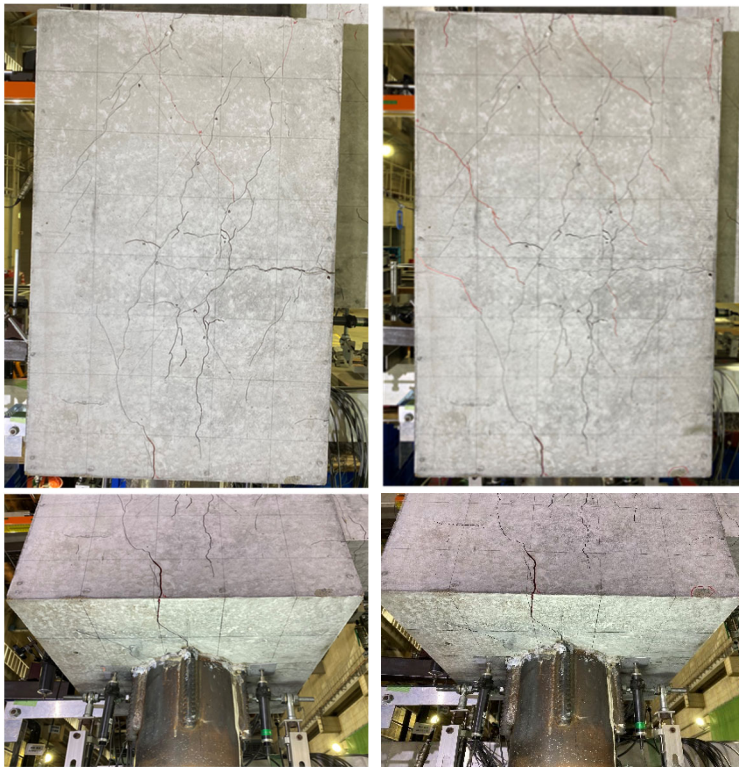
最大耐力時ひび割れ状況 (左 : R=+2.0%、右 : R=-2.0%)
